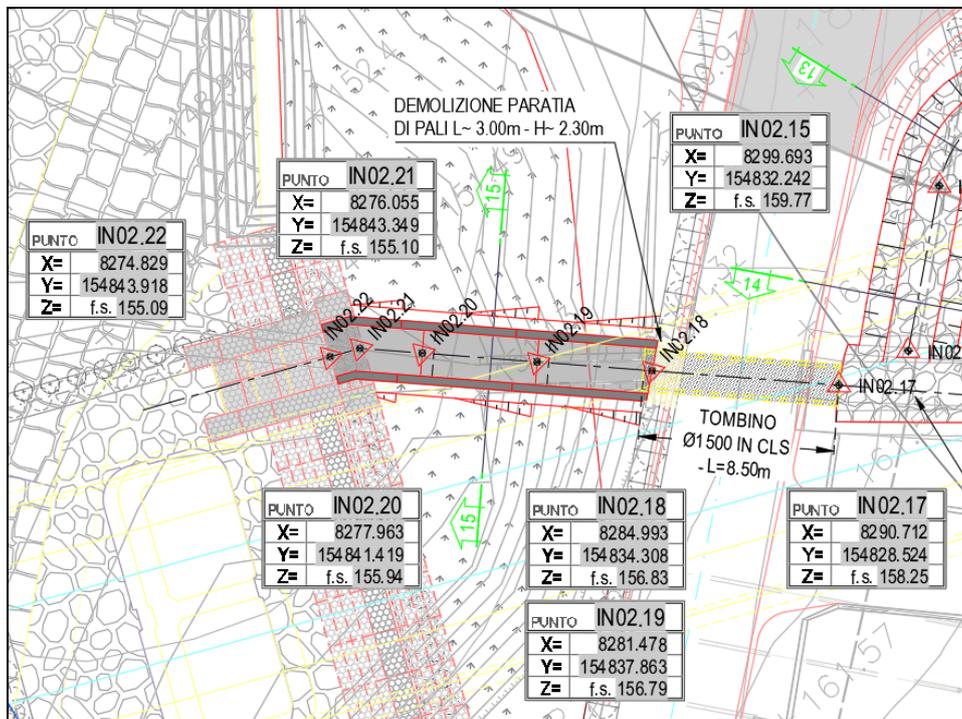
Inalvezione IN02 – Planimetria sbocco IN02 a valle della strada provinciale
